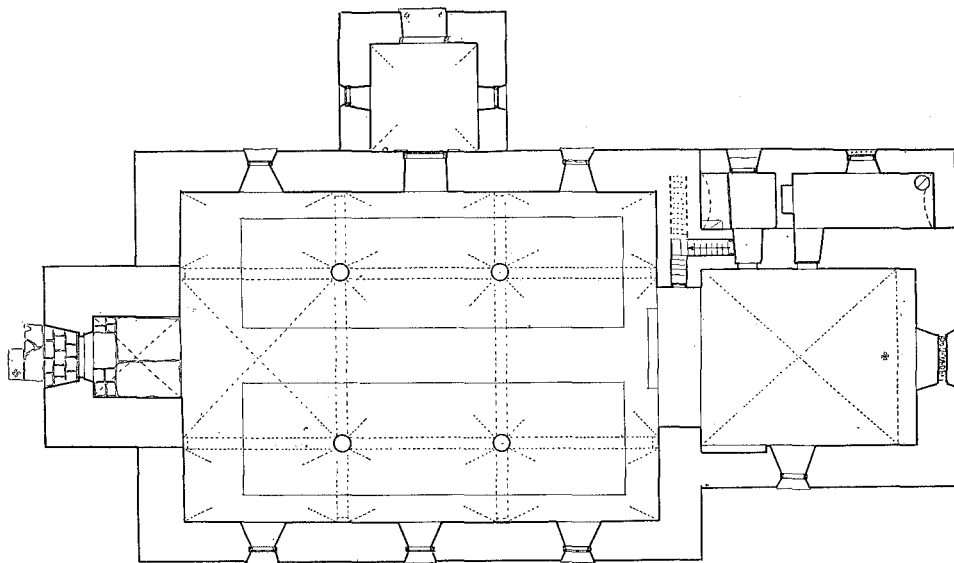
Koeru kyrka. Plan. Efter Kjellin.
